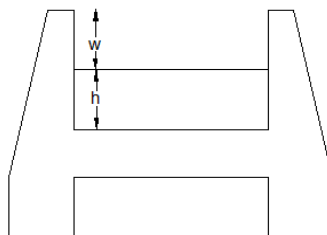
Denah *Long Storage*, pompa dan pintu air
